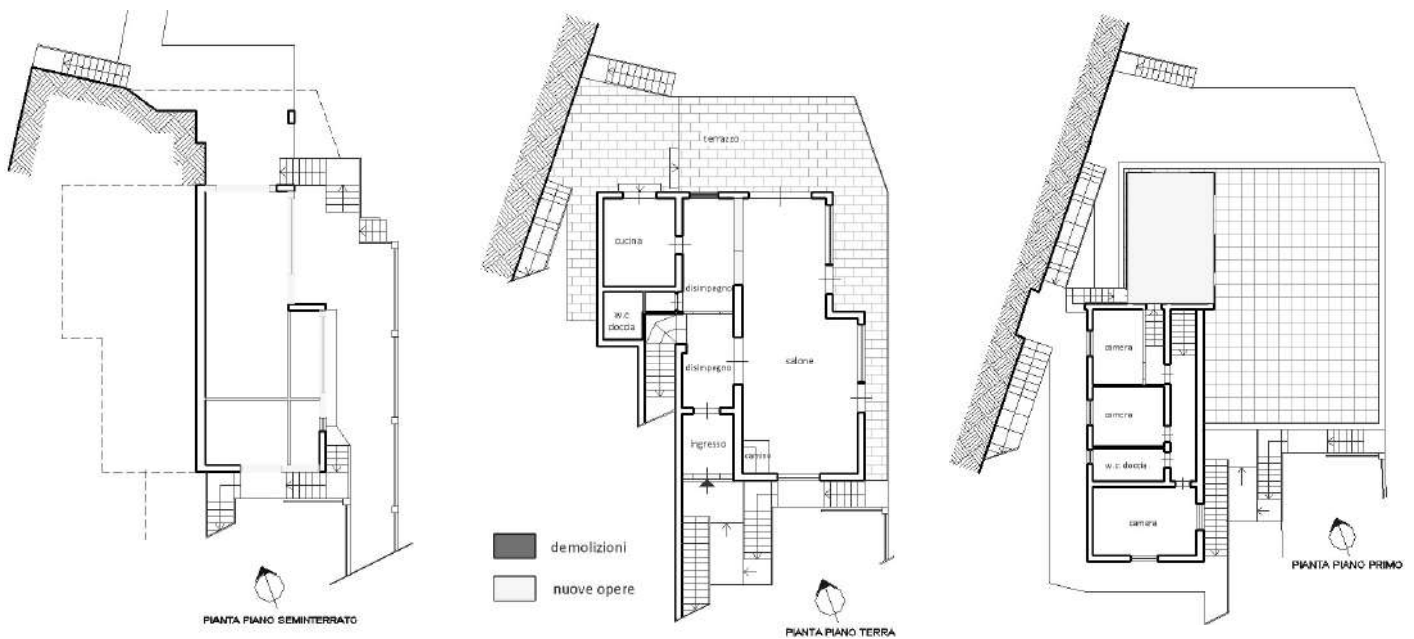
Planimetrie di rilievo delle modifiche effettuate
